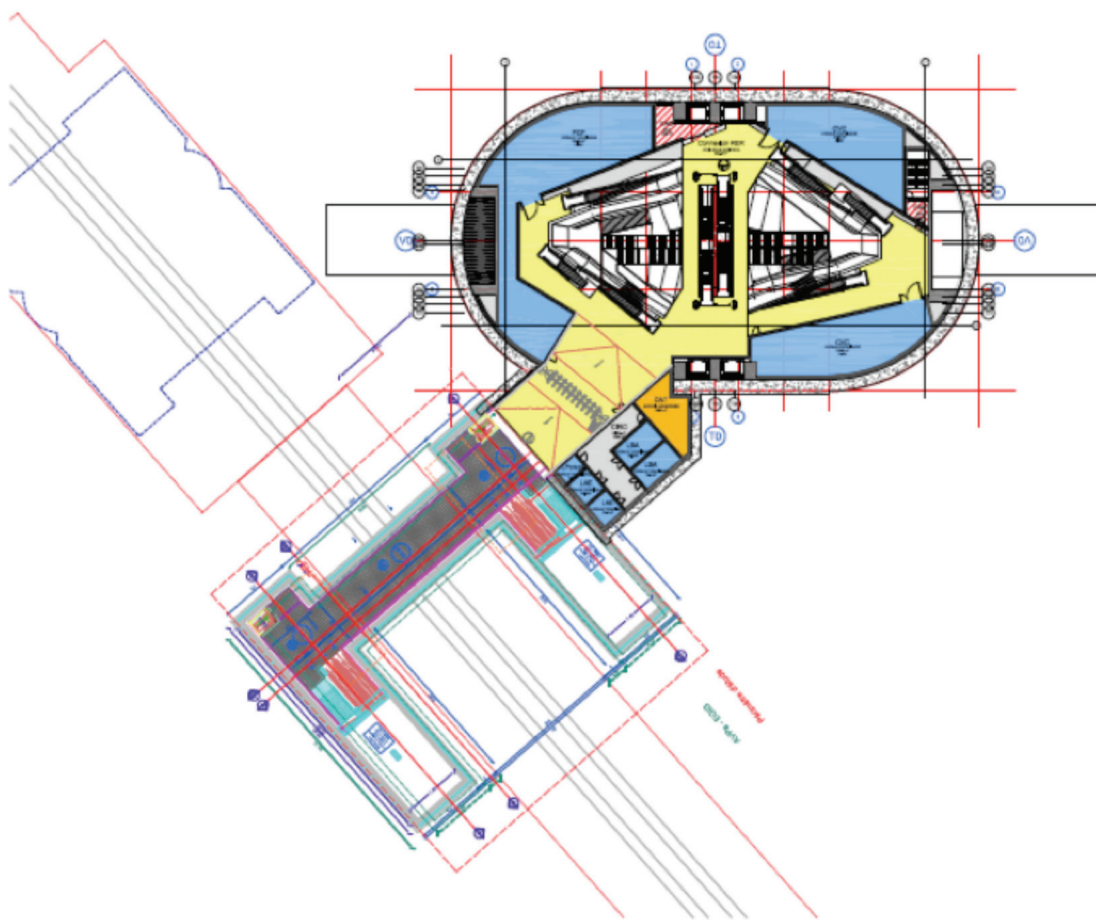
Plan niveau N-2 : niveau passage souterrain
